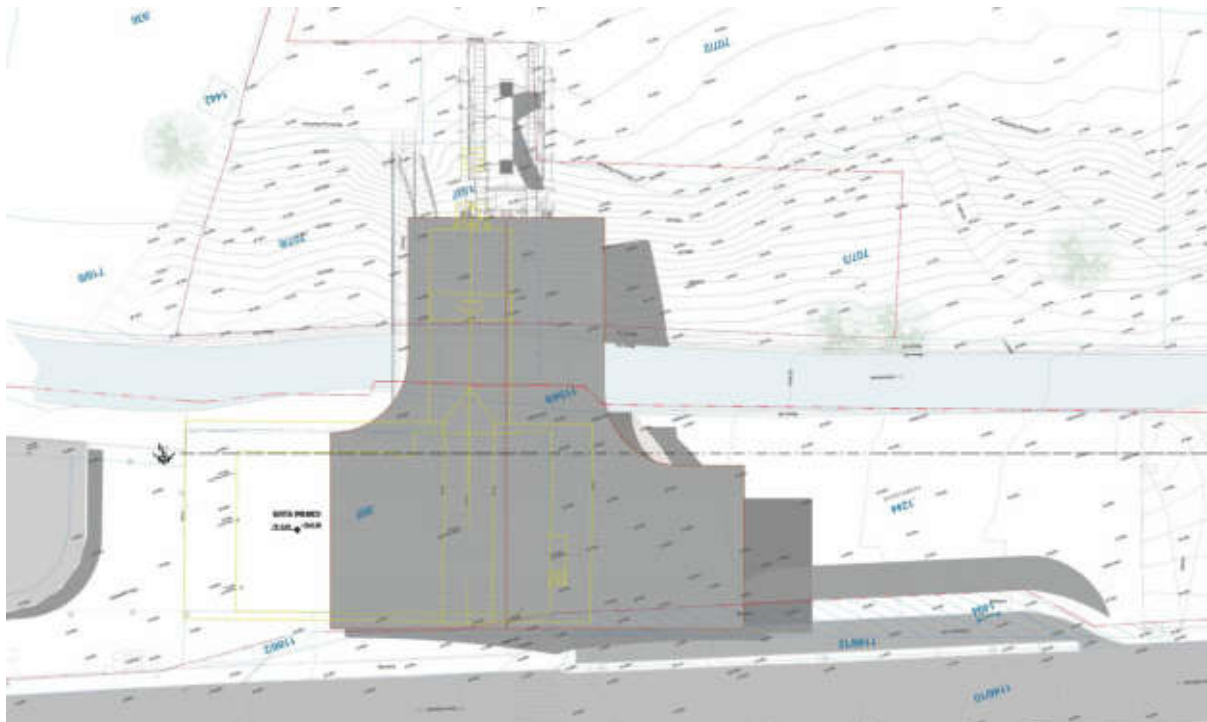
Projektauszug – Lageplan Talstation (Arch. Sader) / stralcio da progetto – planimetria stazione di valle (Arch. Sader)
